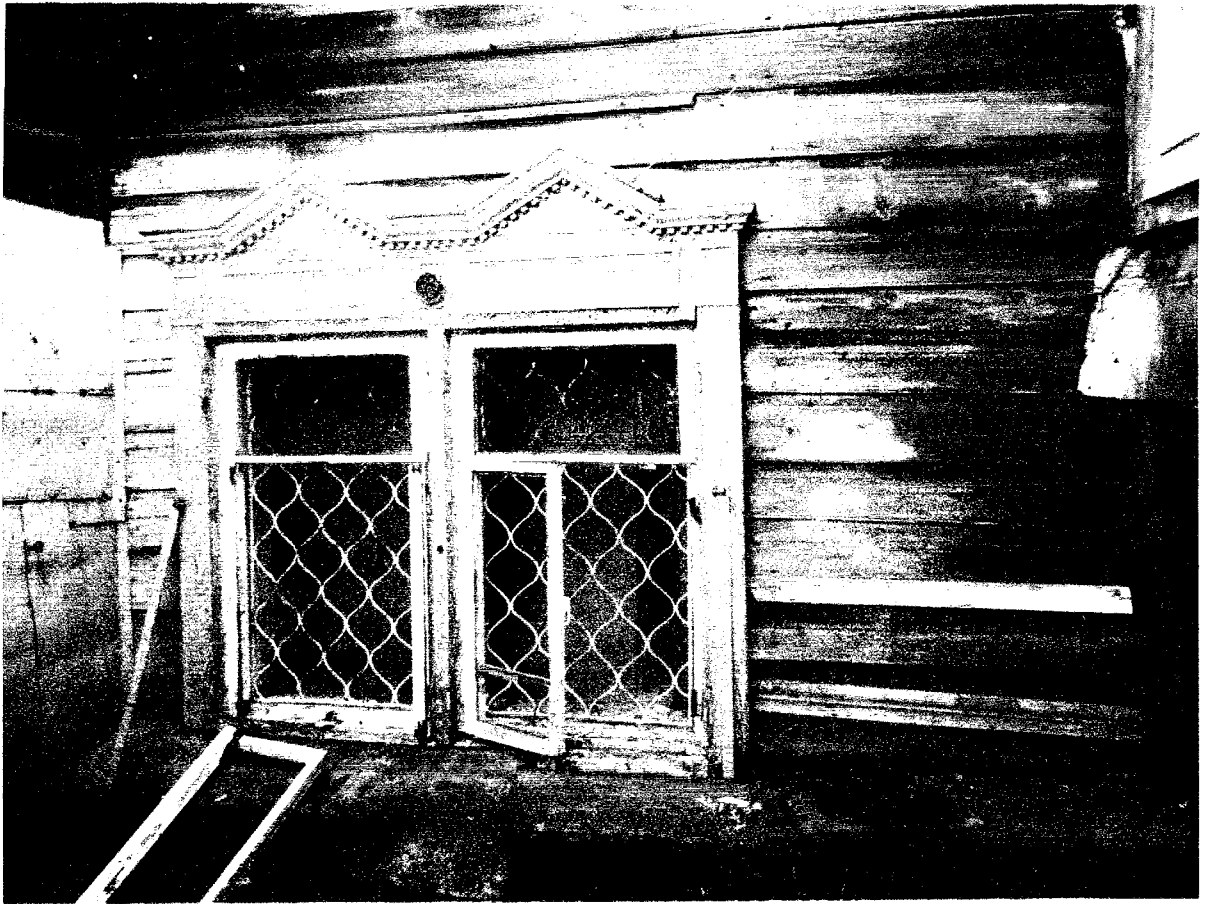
Фрагмент стены дворового северо-западного фасада (лит.А)
